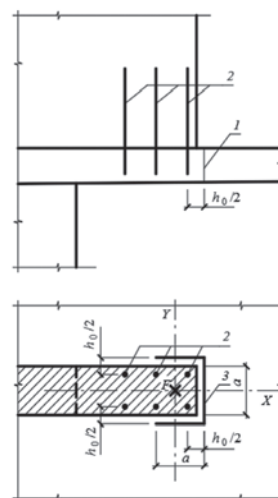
Схема для расчета на продавливание плоской плиты при подвеске перекрытия к вышележащей стене:
